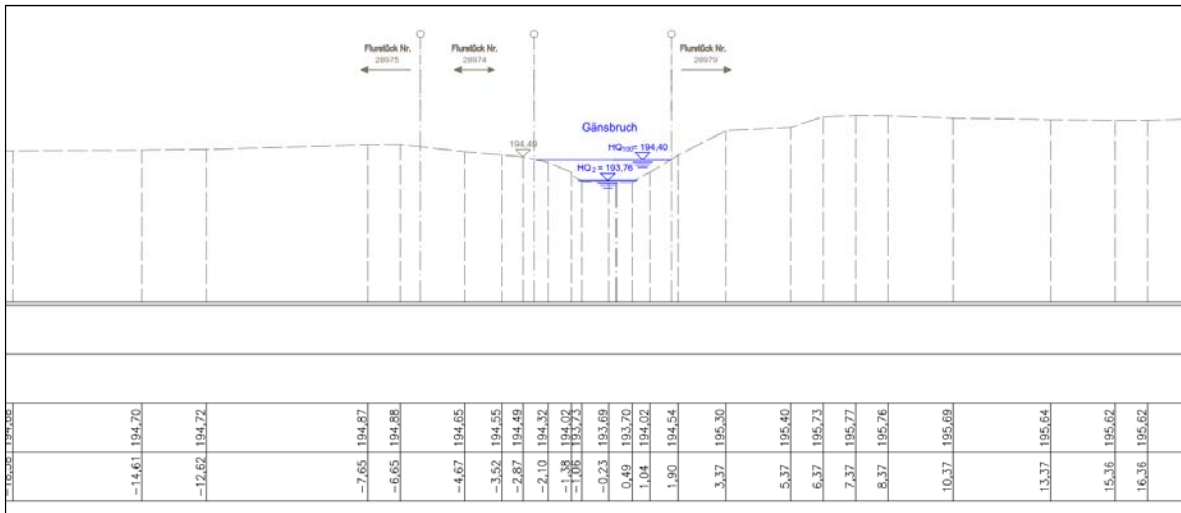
Retentionsraumausgleich – Profil 13 / Station 0+931 (kein Eingriff)
